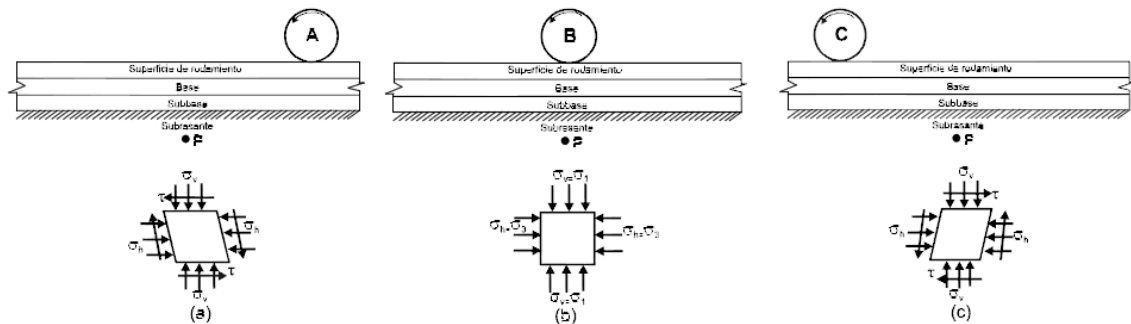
ESTADO DE ESFUERZOS EN LA SUBRASANTE
